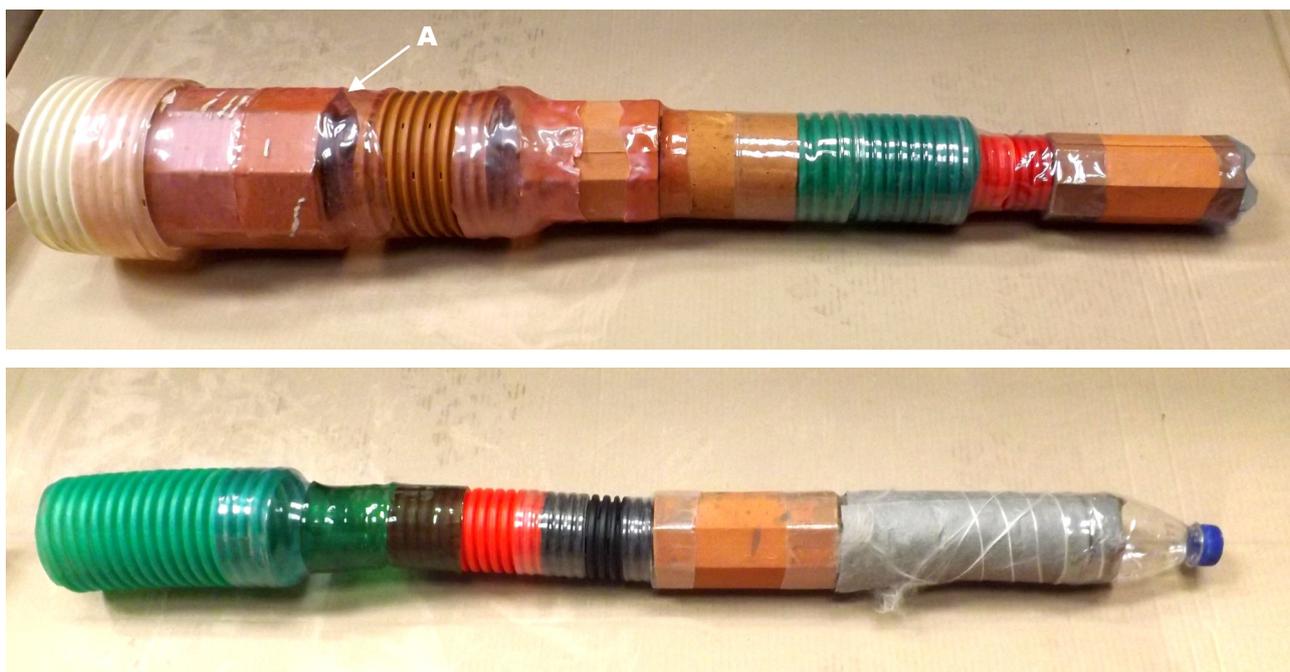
Наборы соединений ПЭТ муфтами-переходниками дренажных трубок подготовленные к испытанием длительной статической нагрузкой
